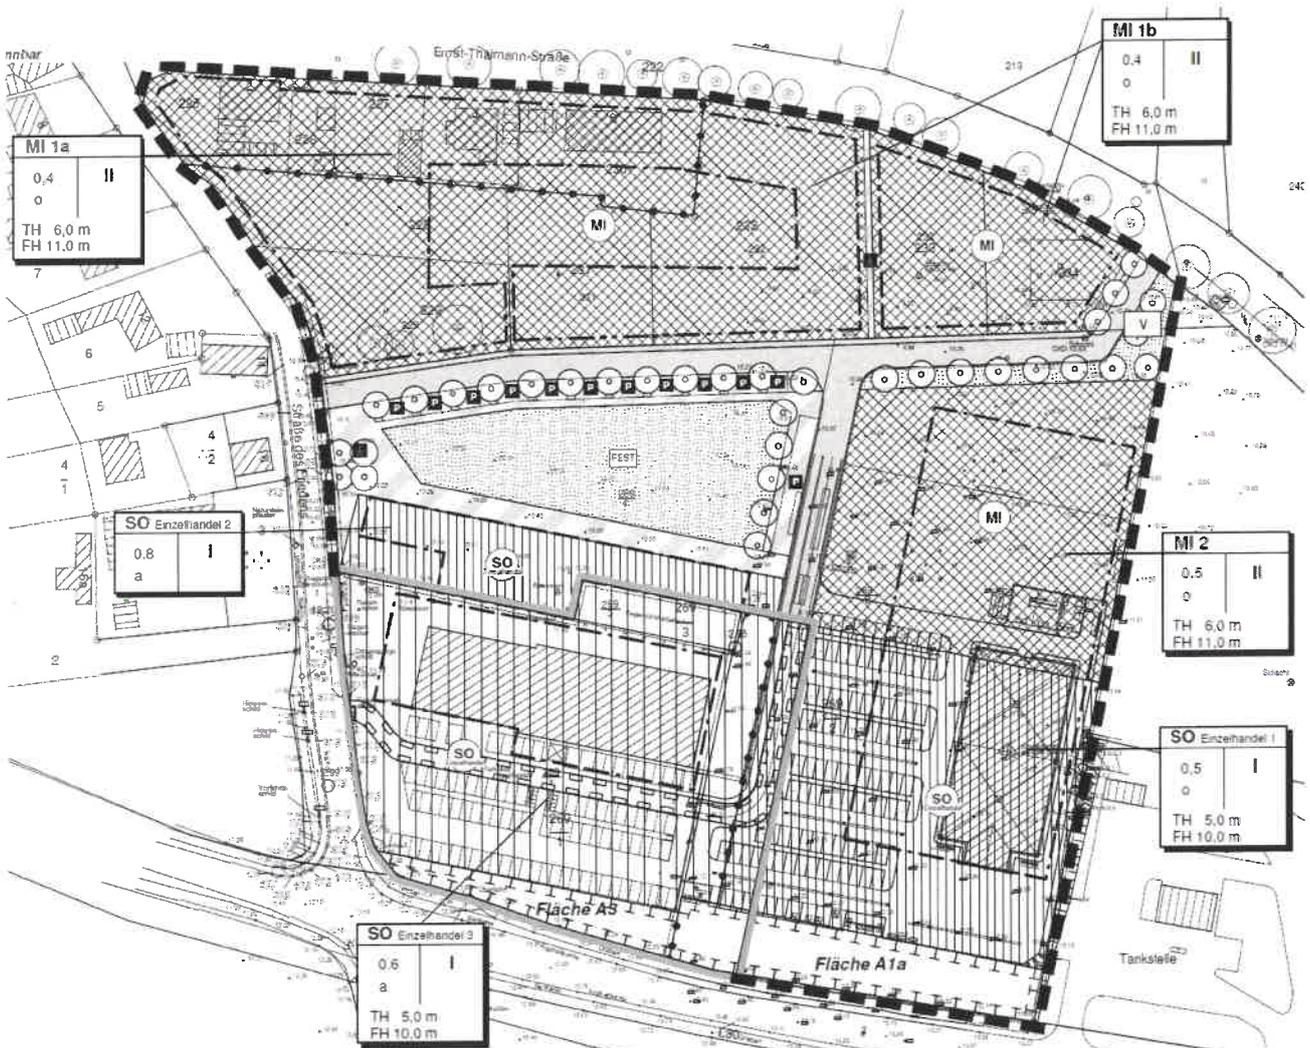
B-Plan Nr. 7 Planzeichnung, Stand 1. Änderung, ohne Maßstab
